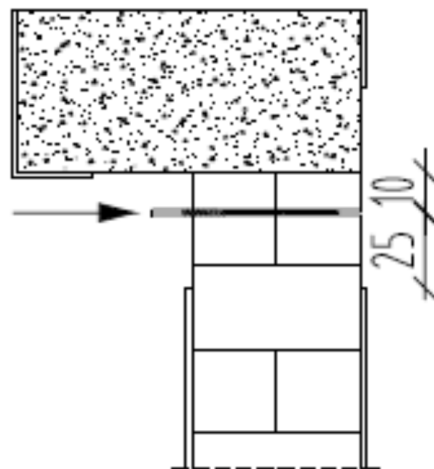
Conexión perimetral a placas y columnas: Paso 2.
